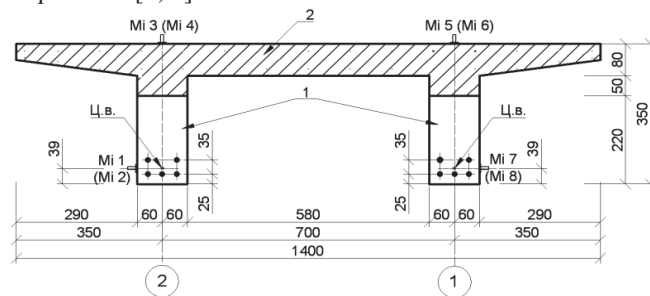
Поперечний переріз дослідної конструкції з розміщення арматури і мікроіндикаторів на дослідній конструкції в середині прогону який навантажували:
